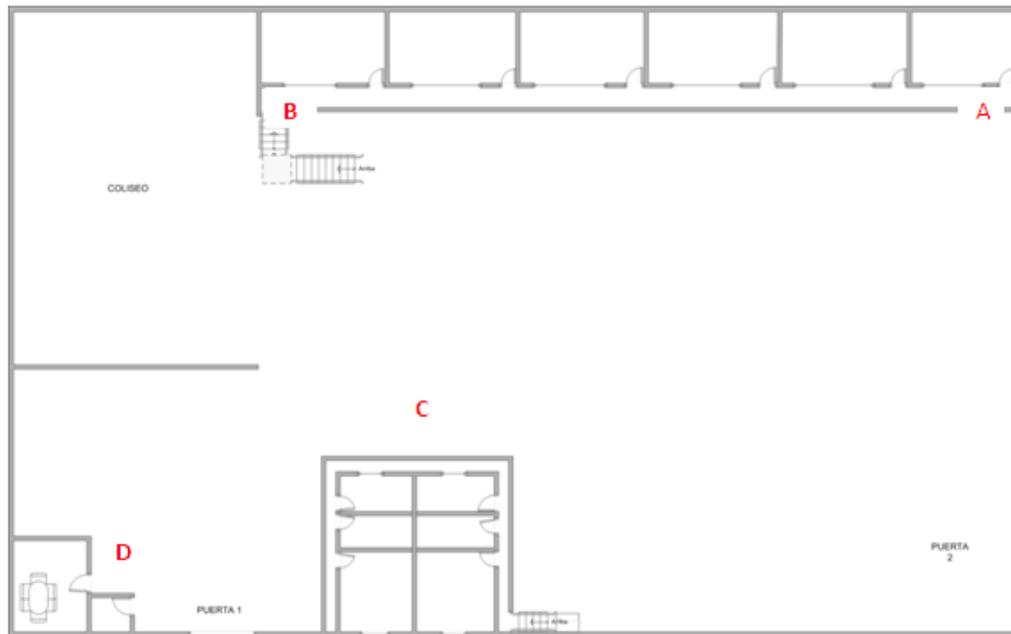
Plano de la Academia Aeronáutica Elia Liut
